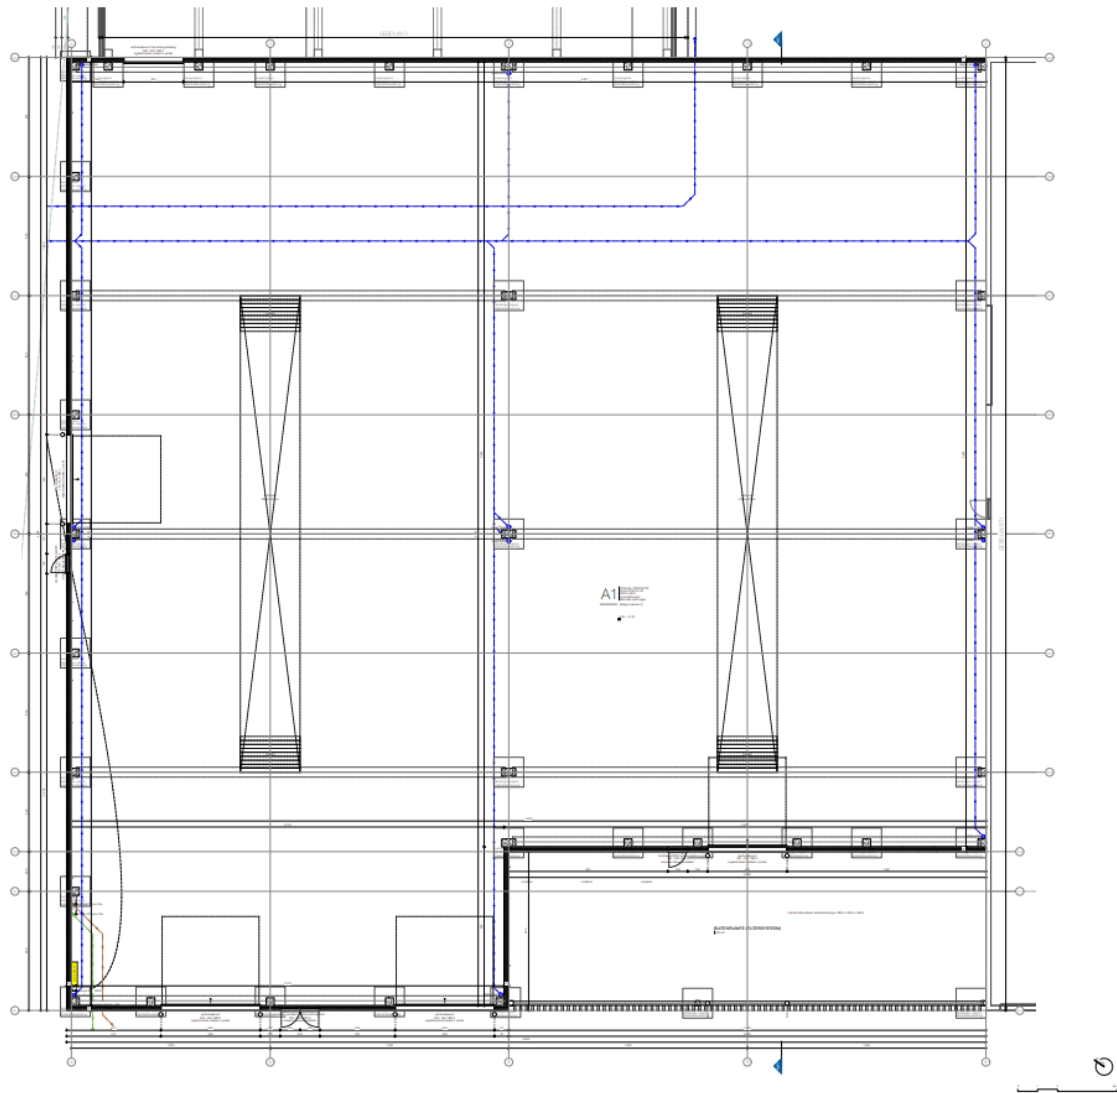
Plan van de geplande verkaveling (opdrachtgever, 2021)
